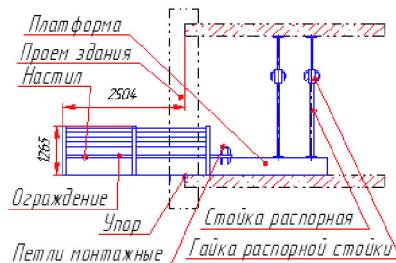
Схема конструктивного решения выносной грузоприемной площадки, устанавливаемой в дверной проем
